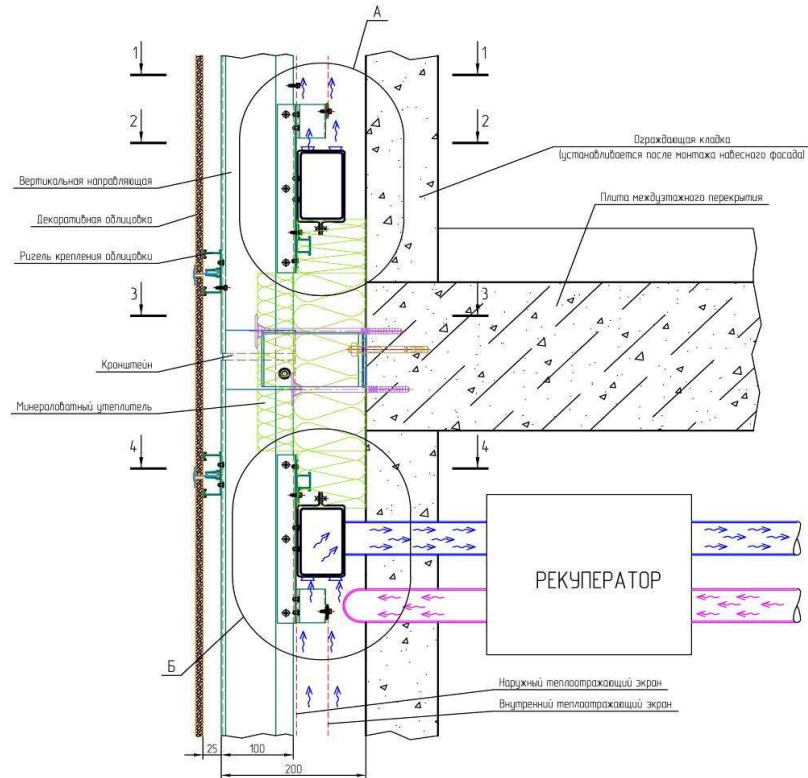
Навесная фасадная система с вентилируемым воздушным зазором НФС с ВВЗ (вариант крепления в межэтажные перекрытия)
